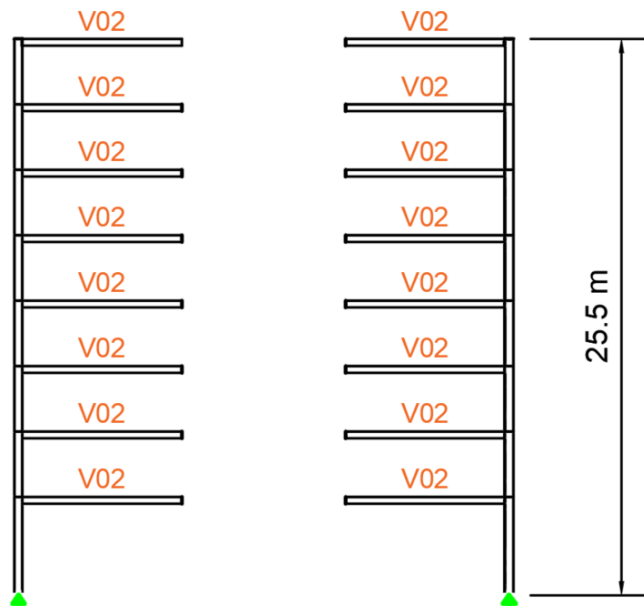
Elevación Eje 3 Edificio 8 Pisos.
